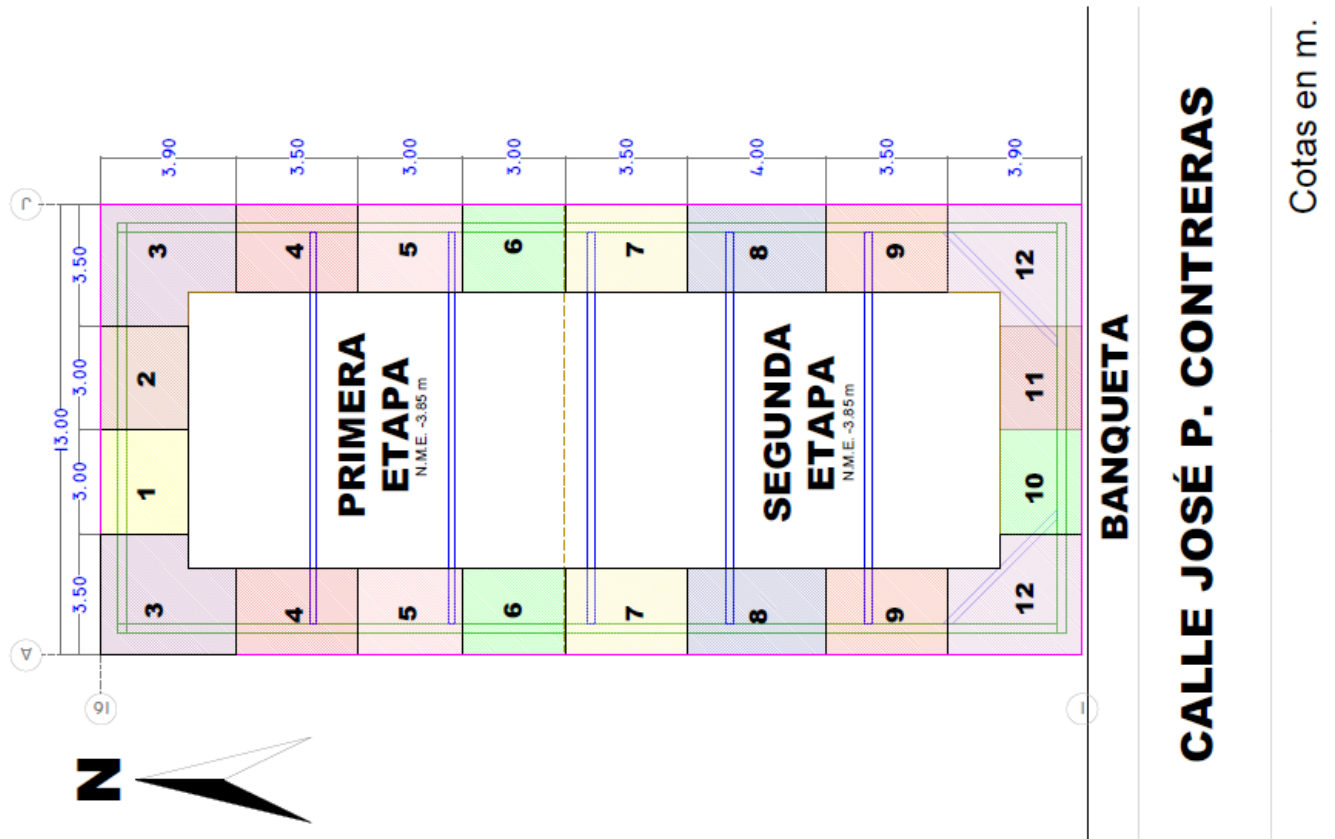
MODULACIÓN DE LA BERMA PARA LA CONSTRUCCIÓN DEL MURO BERLÍN
